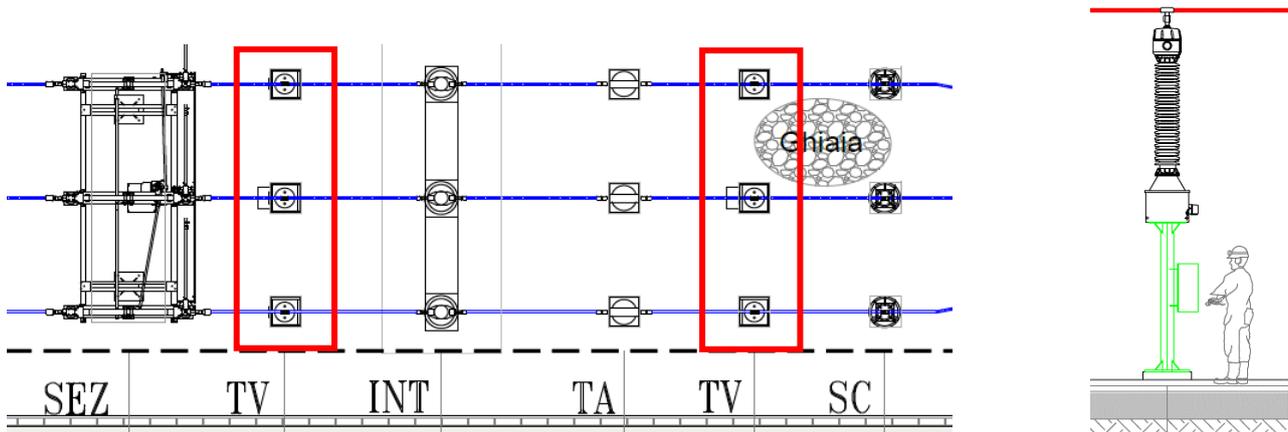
Tipico Trasformatore di tensione – vista prospettica e planimetrica
